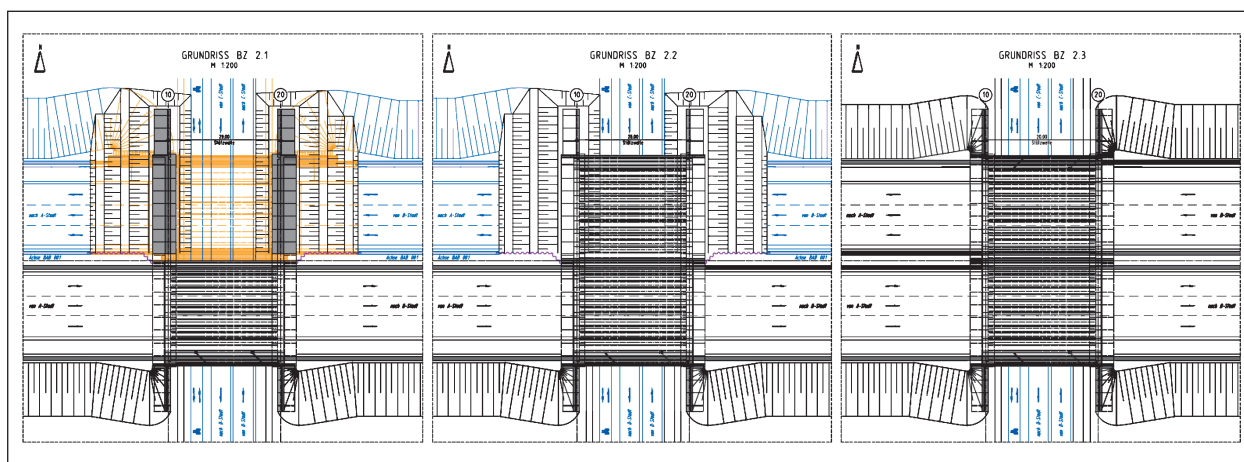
Aufbau des nördlichen Teilbauwerkes
